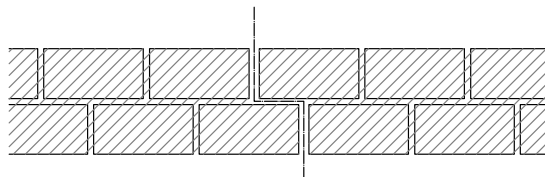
Junta de dilatació amb cavalcament. Esquema en planta
